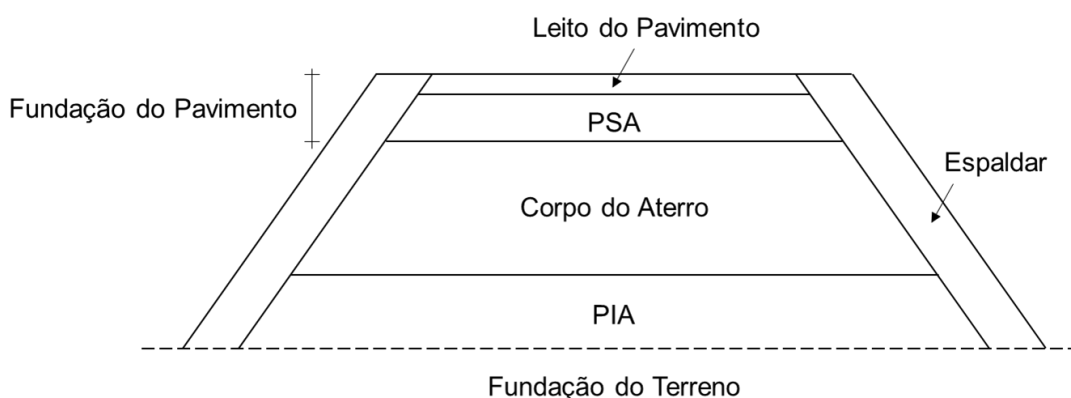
Esquema estrutural do aterro (adaptado de Ribeiro, 2008)
